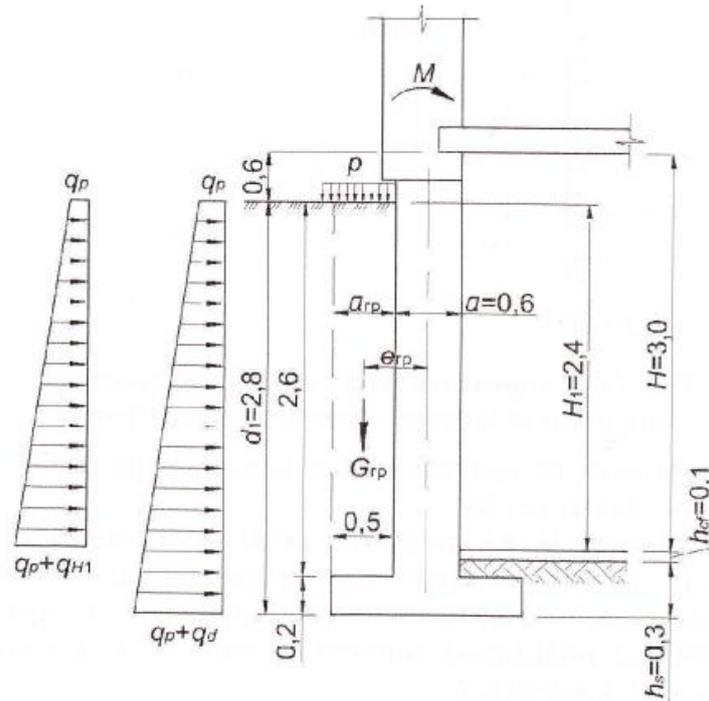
Расчетная схема ленточного фундамента здания с подвалом
